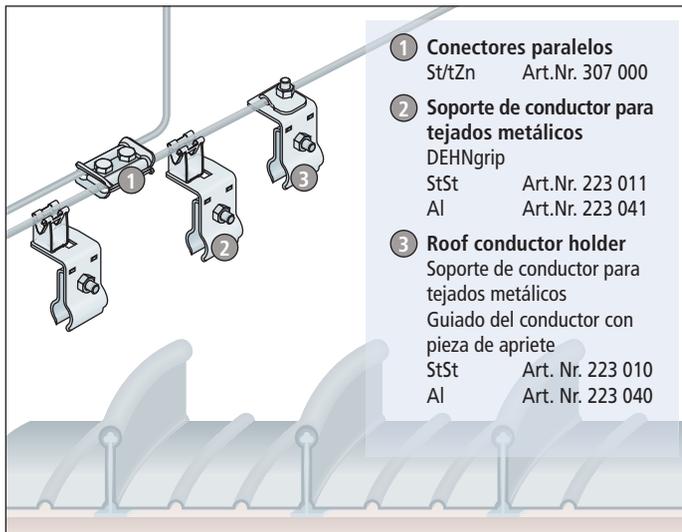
Soporte de conductores para tejado metálico - Tejado con junta redonda.
